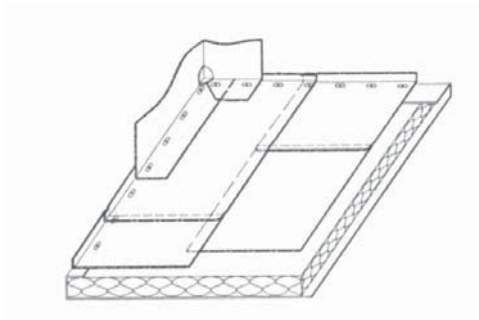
Fixation en pied de relevé par vis et plaquettes
